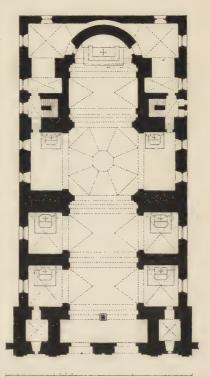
Jesuitenkirche zu Innsbruck. Grundriss.
